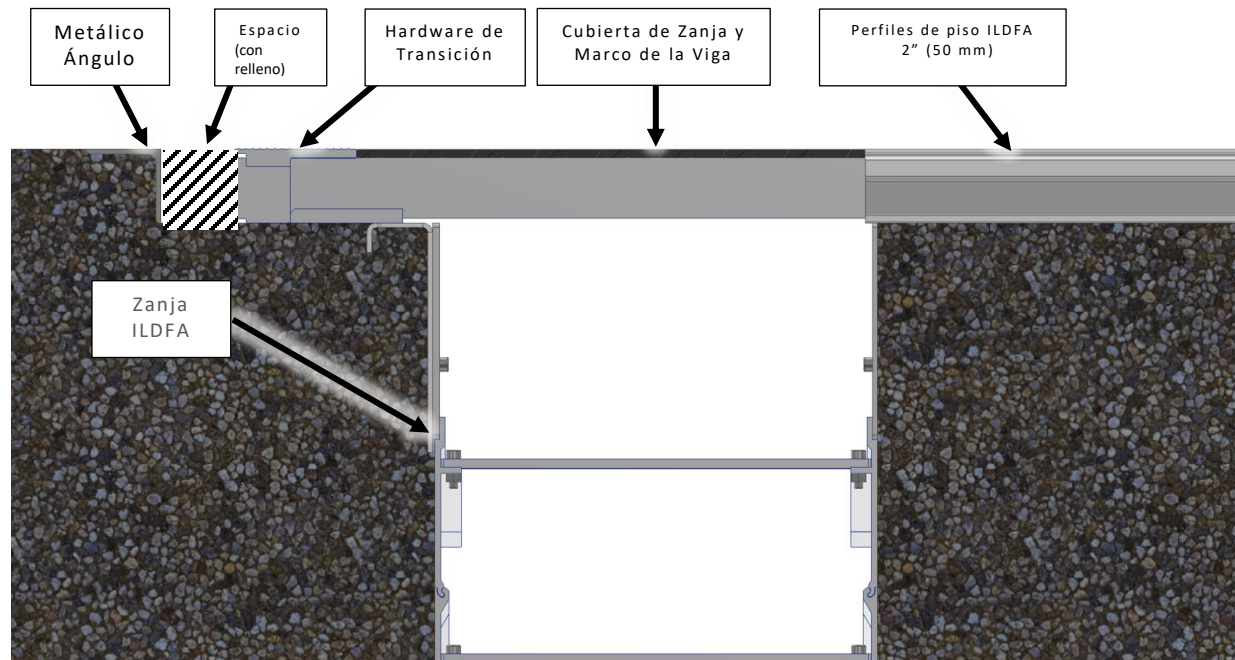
Transición de Losa de Hangar a ILDFA en zanjas
